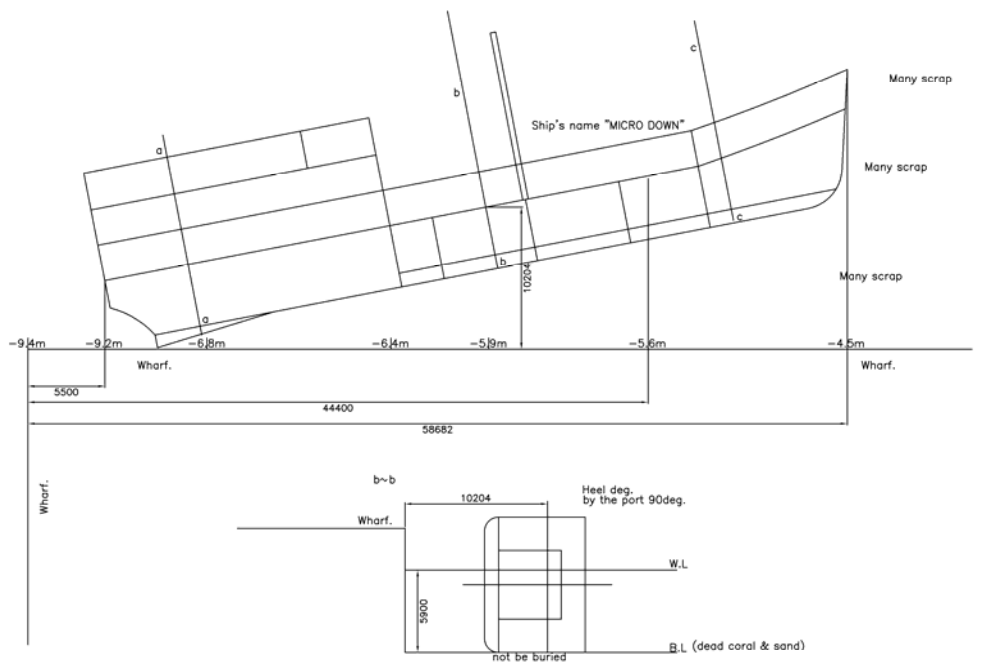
C 岸壁前面 沈船船体図 (平面図及び船体断面図)
